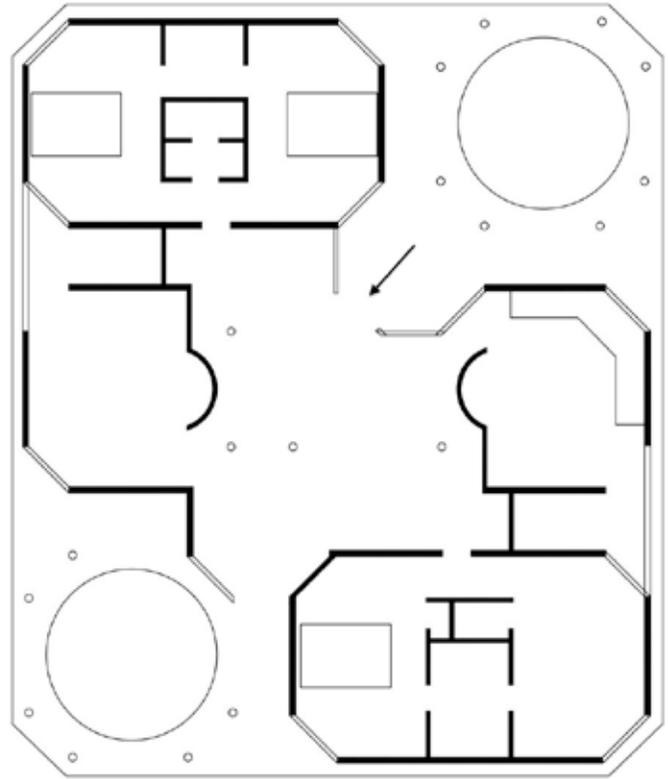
Planta de piso de la Casa Visser del arquitecto Aldo van Eyck (1980).
